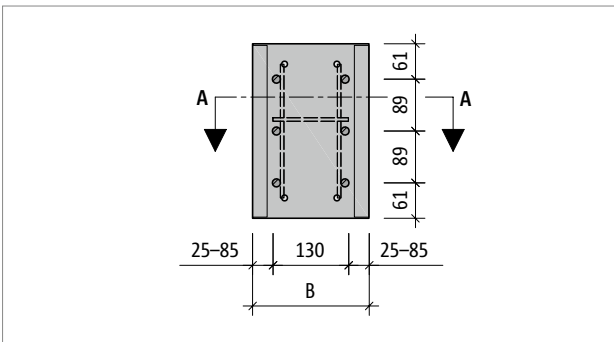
Schöck Sconnex® Typ W-T2: Produktgrundriss
